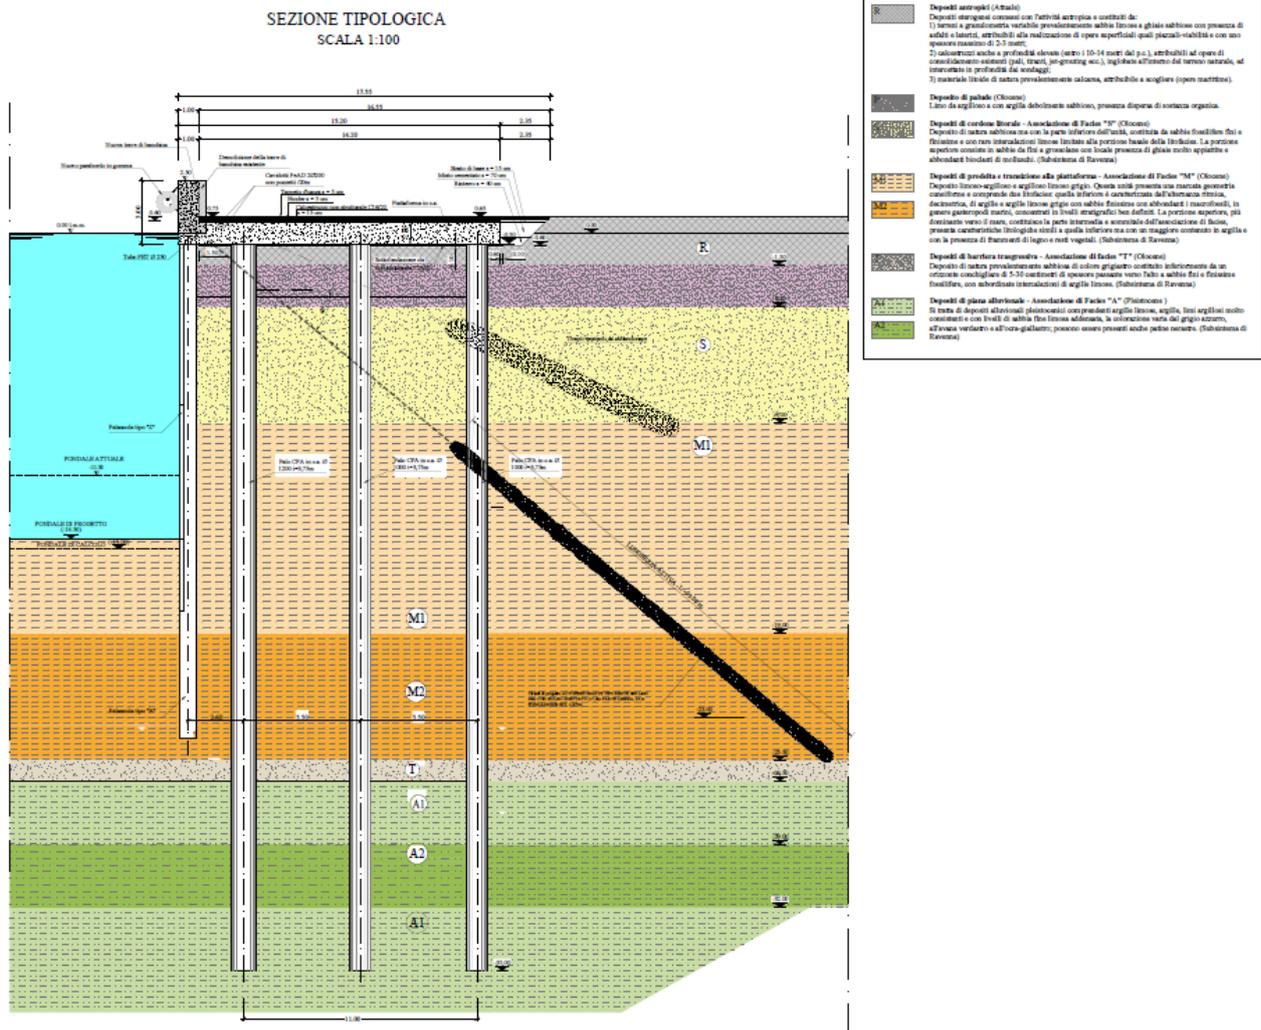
Bunge Sud – Progetto Esecutivo Soluzione – Sezione intervento
